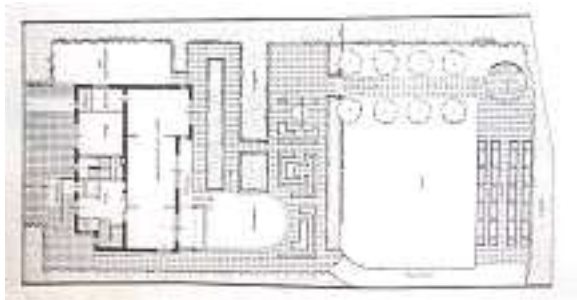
Haus Krasny, Grundriss des Erdgeschosses und Gartenplan, 1927-28 (Moderne Bauformen, 1930).
